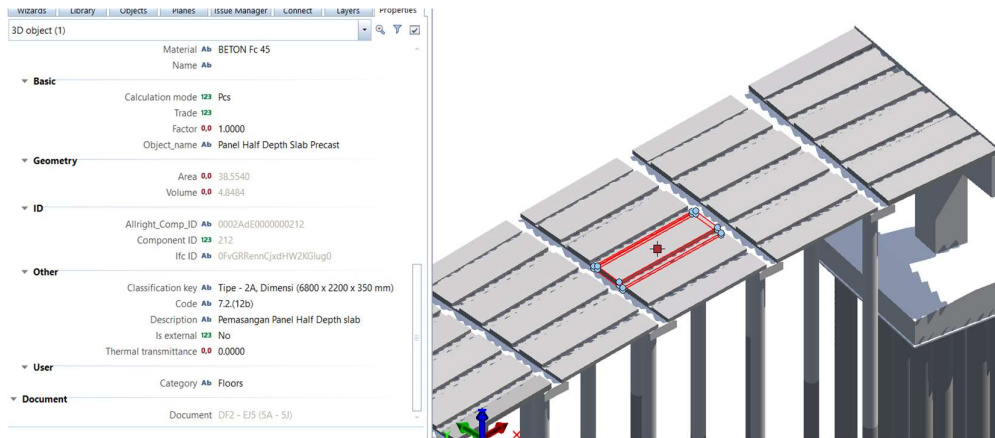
Model *Redesign Half Slab* yang Terpasang
